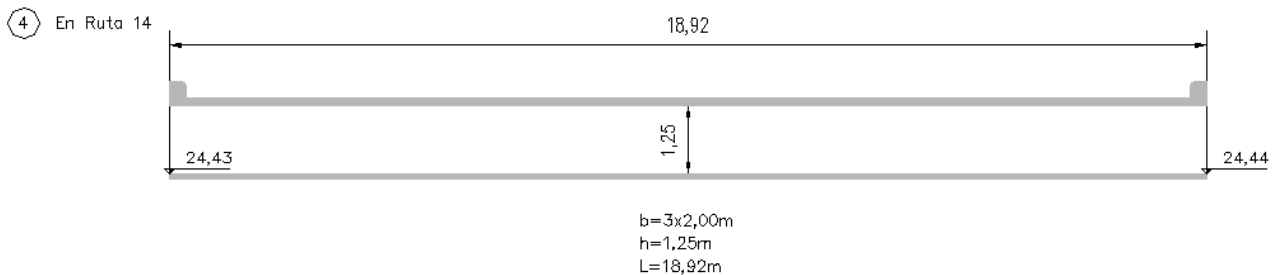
Perfil longitudinal de la alcantarilla
